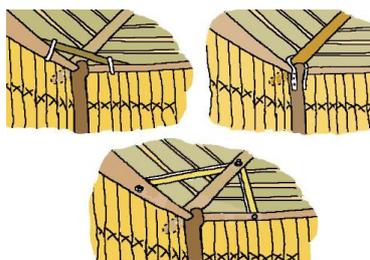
Conexão rígida com braçadeiras metálicas, paus e corda
